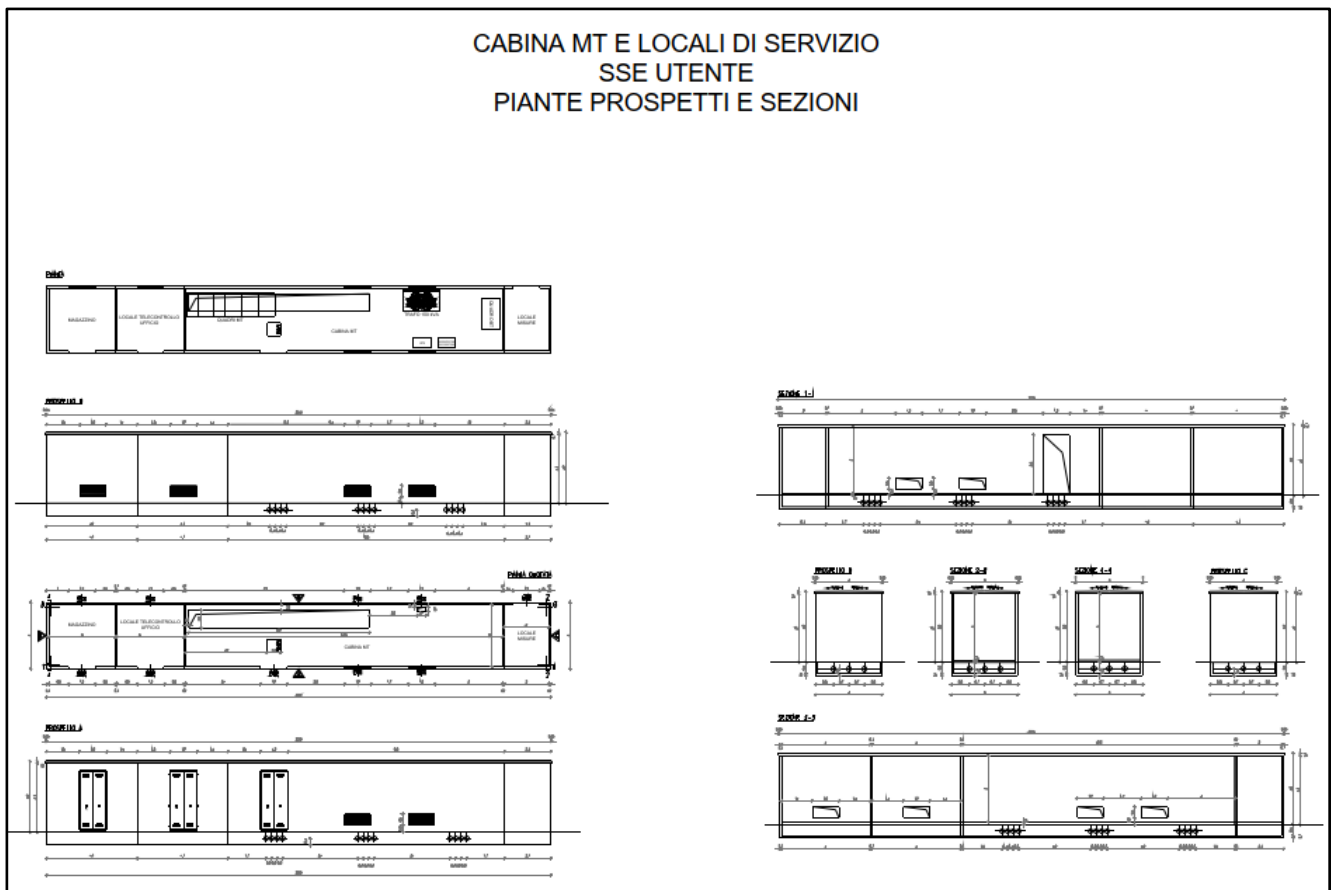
Pianta, prospetti e Sezioni della Sottostazione Utente
